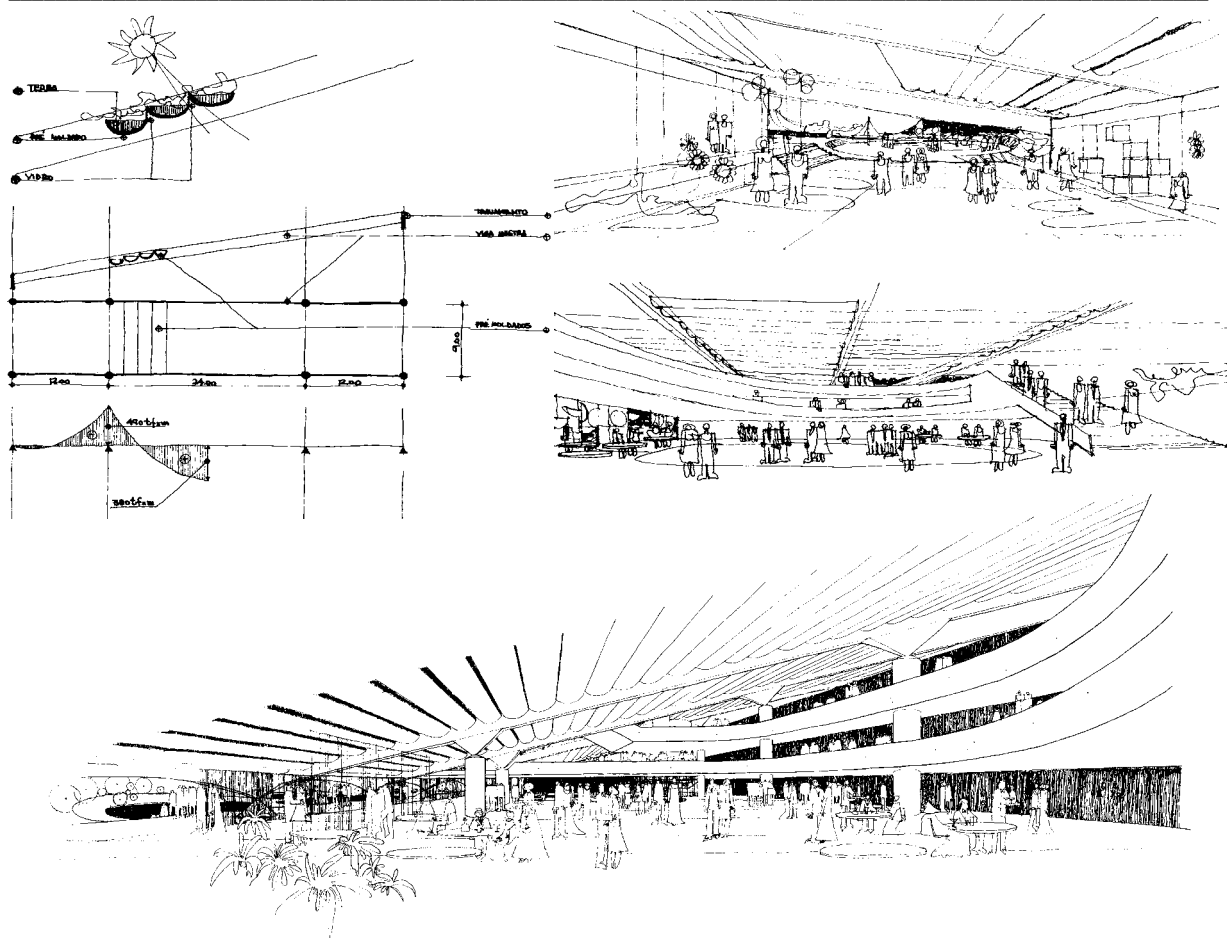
2º prêmio; esquema da estrutura; vigas inclinadas transversais apoiadas contra quatro pilares; vão: A, B, A.
